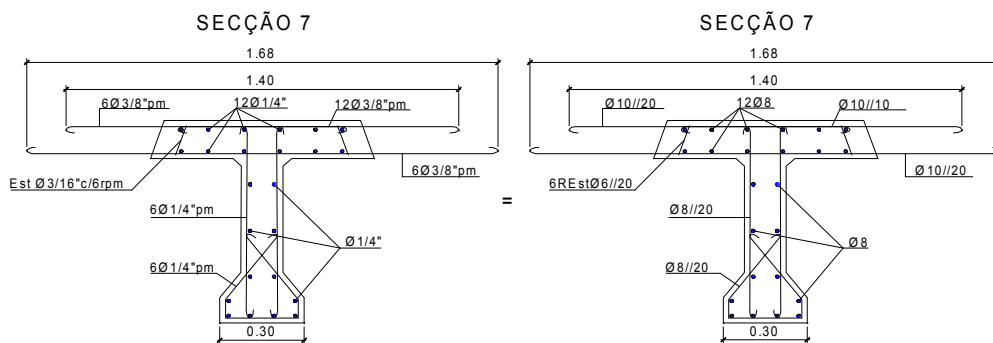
Armadura na secção de meio vão de uma longarina (ponte sobre o rio Save).
